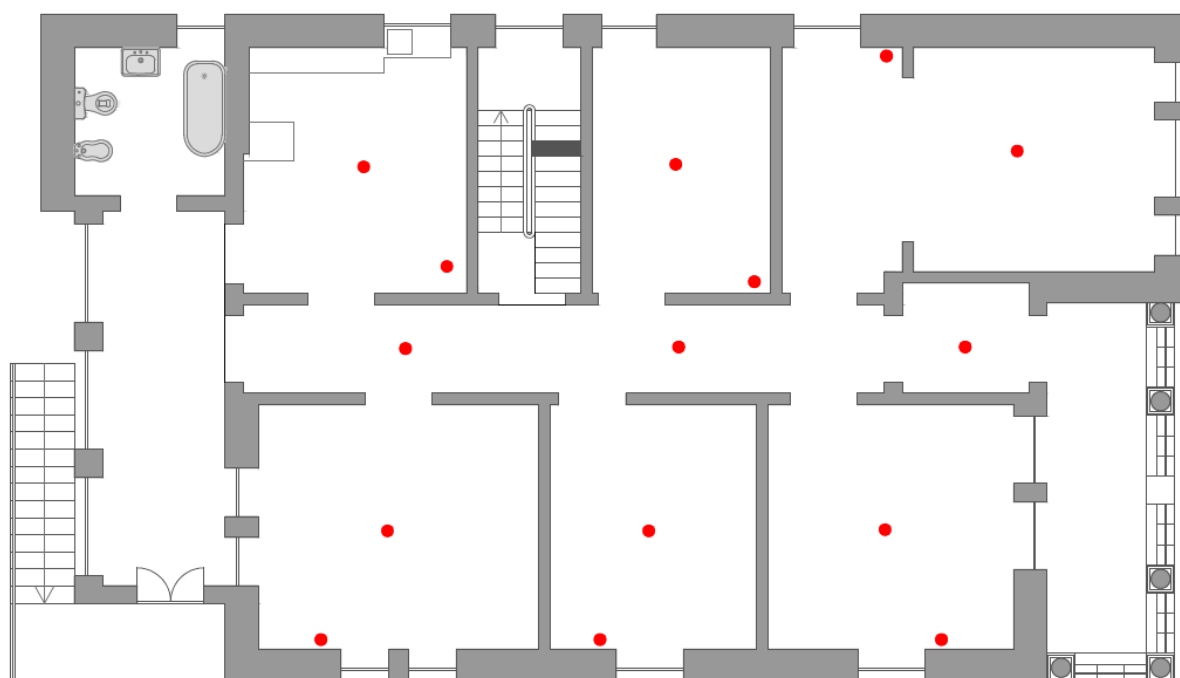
Identificação dos pontos de ensaio com Resistógrafo. Piso 1
